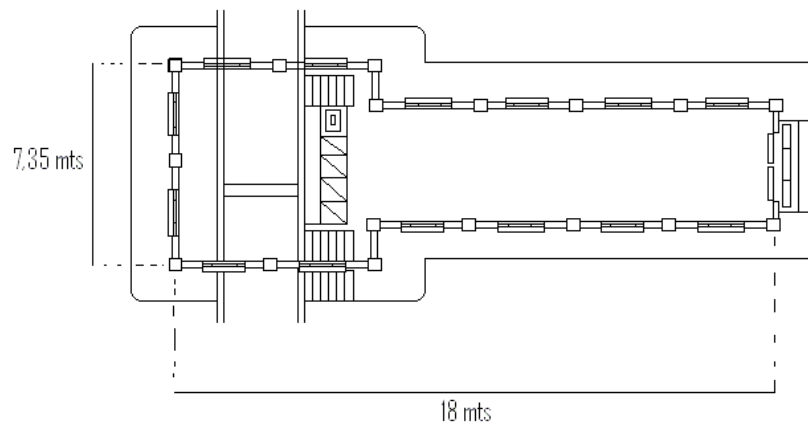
Plano arquitectónico - Sala de Dosificación Planta El Tablazo
